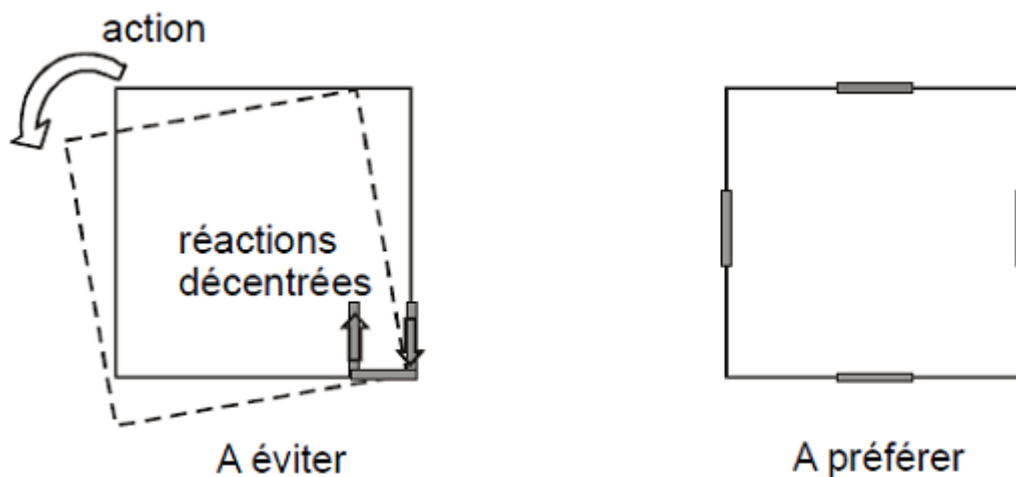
Impact du positionnement des éléments rigides sur la torsion dans le bâtiment.
